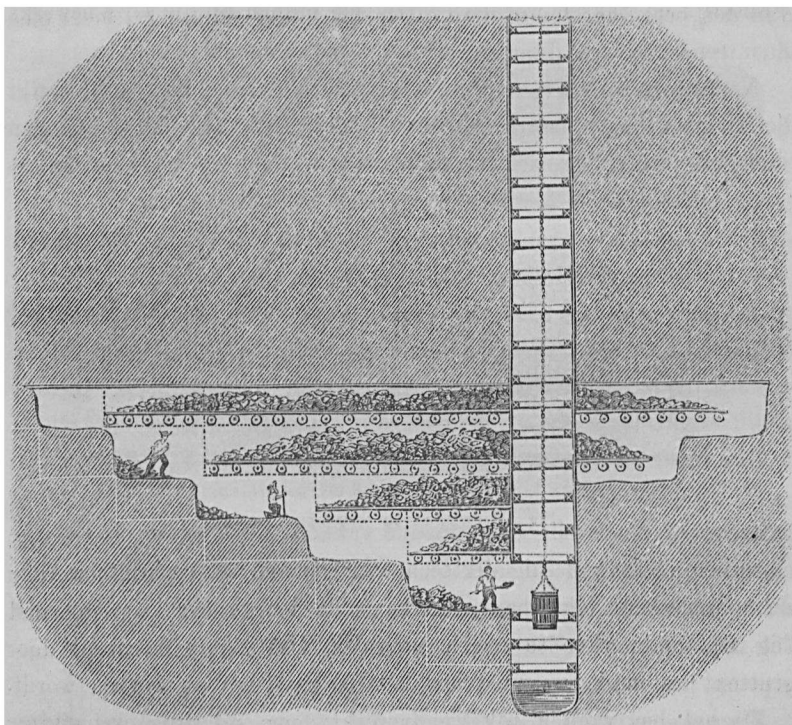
BEWERKING MET REGTE TRAPPEN.
